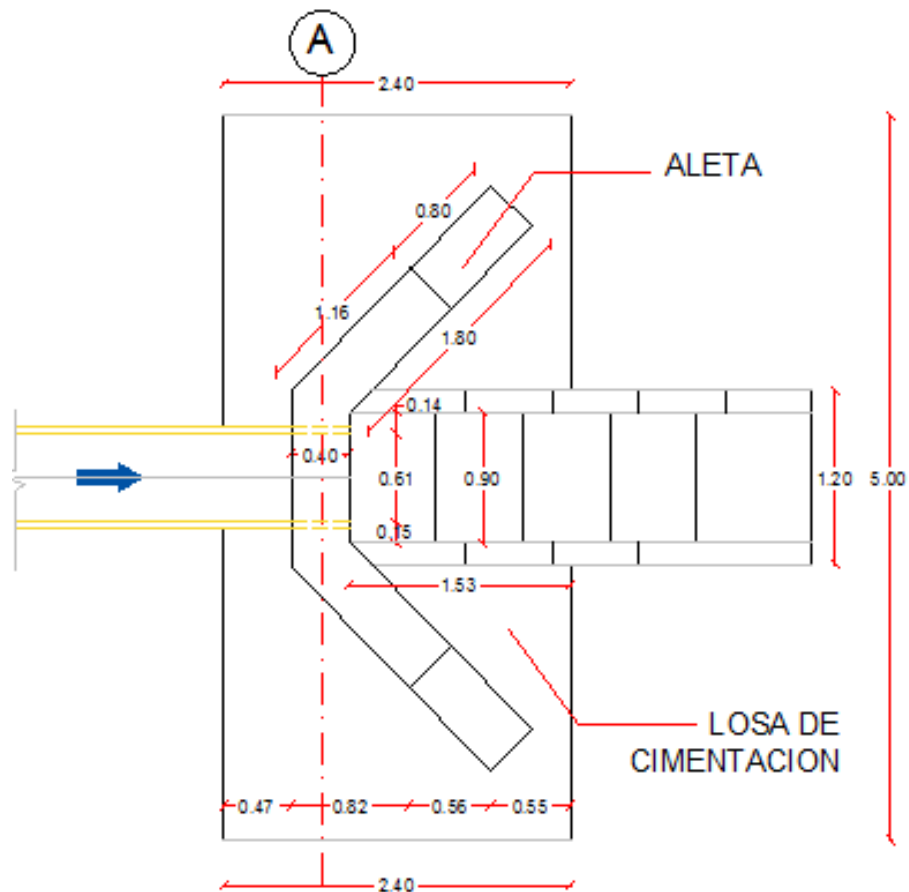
Instalación tubería pluvial de 24 pulg
